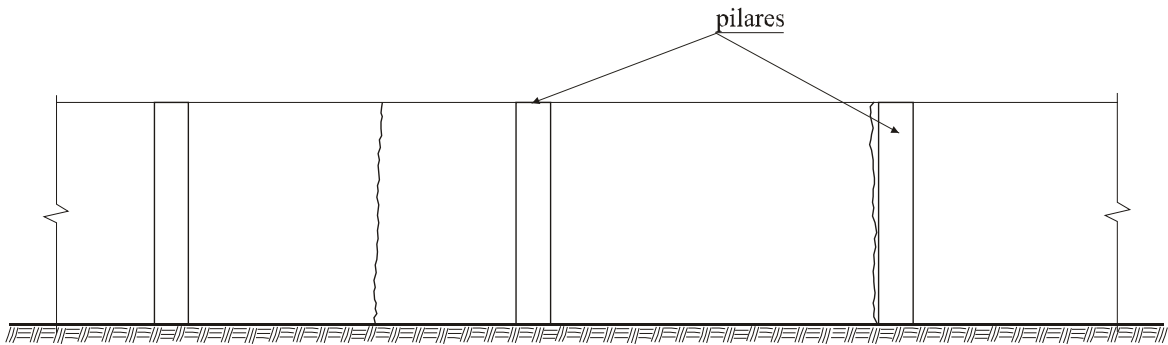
Fissuras em muros de alvenaria causadas por movimentações térmicas
